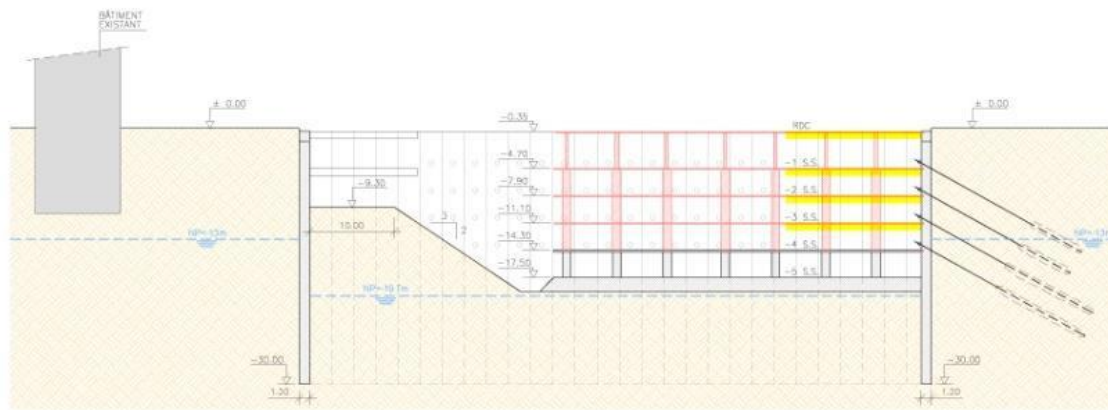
Fase constructiva 17, 18, 19 i 20.
